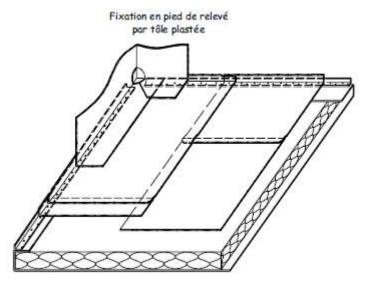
fixation en pied de relevé par tôle plastée / colaminée
